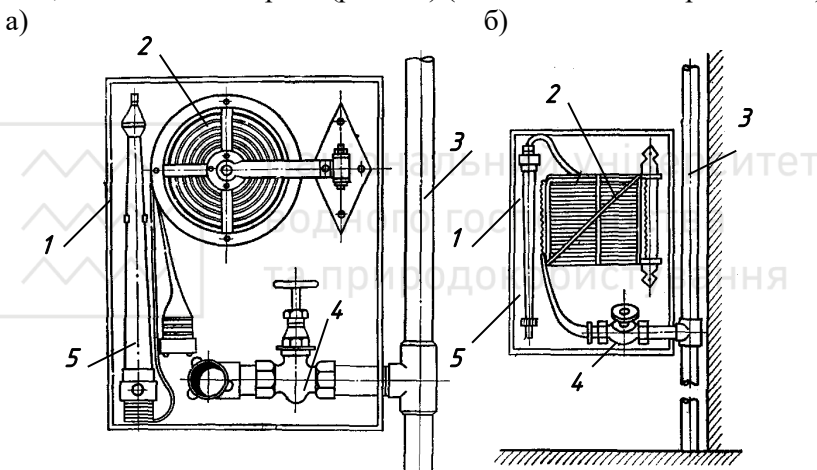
Схема розташування пожежного крану на внутрішньому пожежному му водопроводі: а – на котушці; б – у кошику
